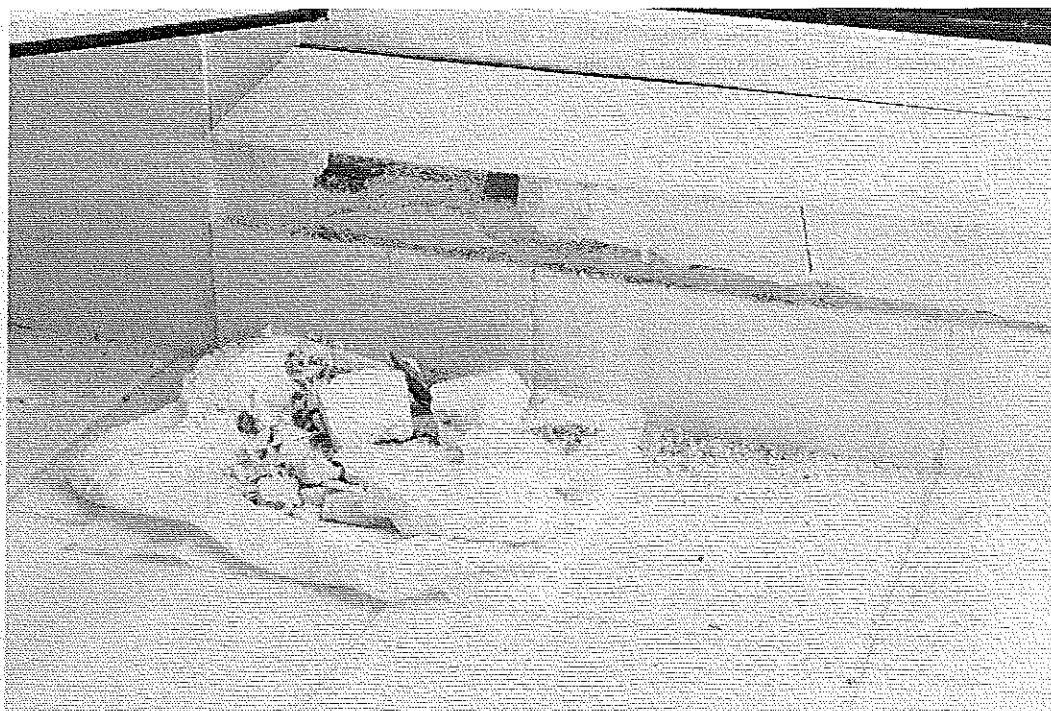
Défaut de liaison et d'étanchéité au droit d'un seuil. © J. Putatti
